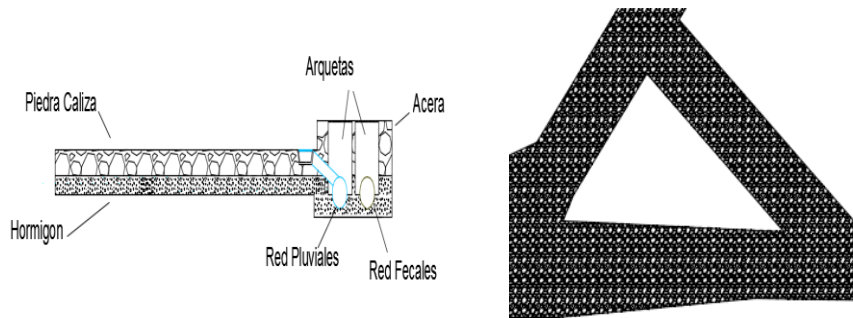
Pavimentación de la pedanía. Fuente: Autor
